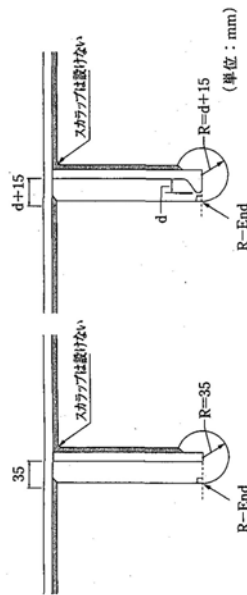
平板リブ又はバルブプレートリブと中間横リブ又は横桁との交差部構造の標準
